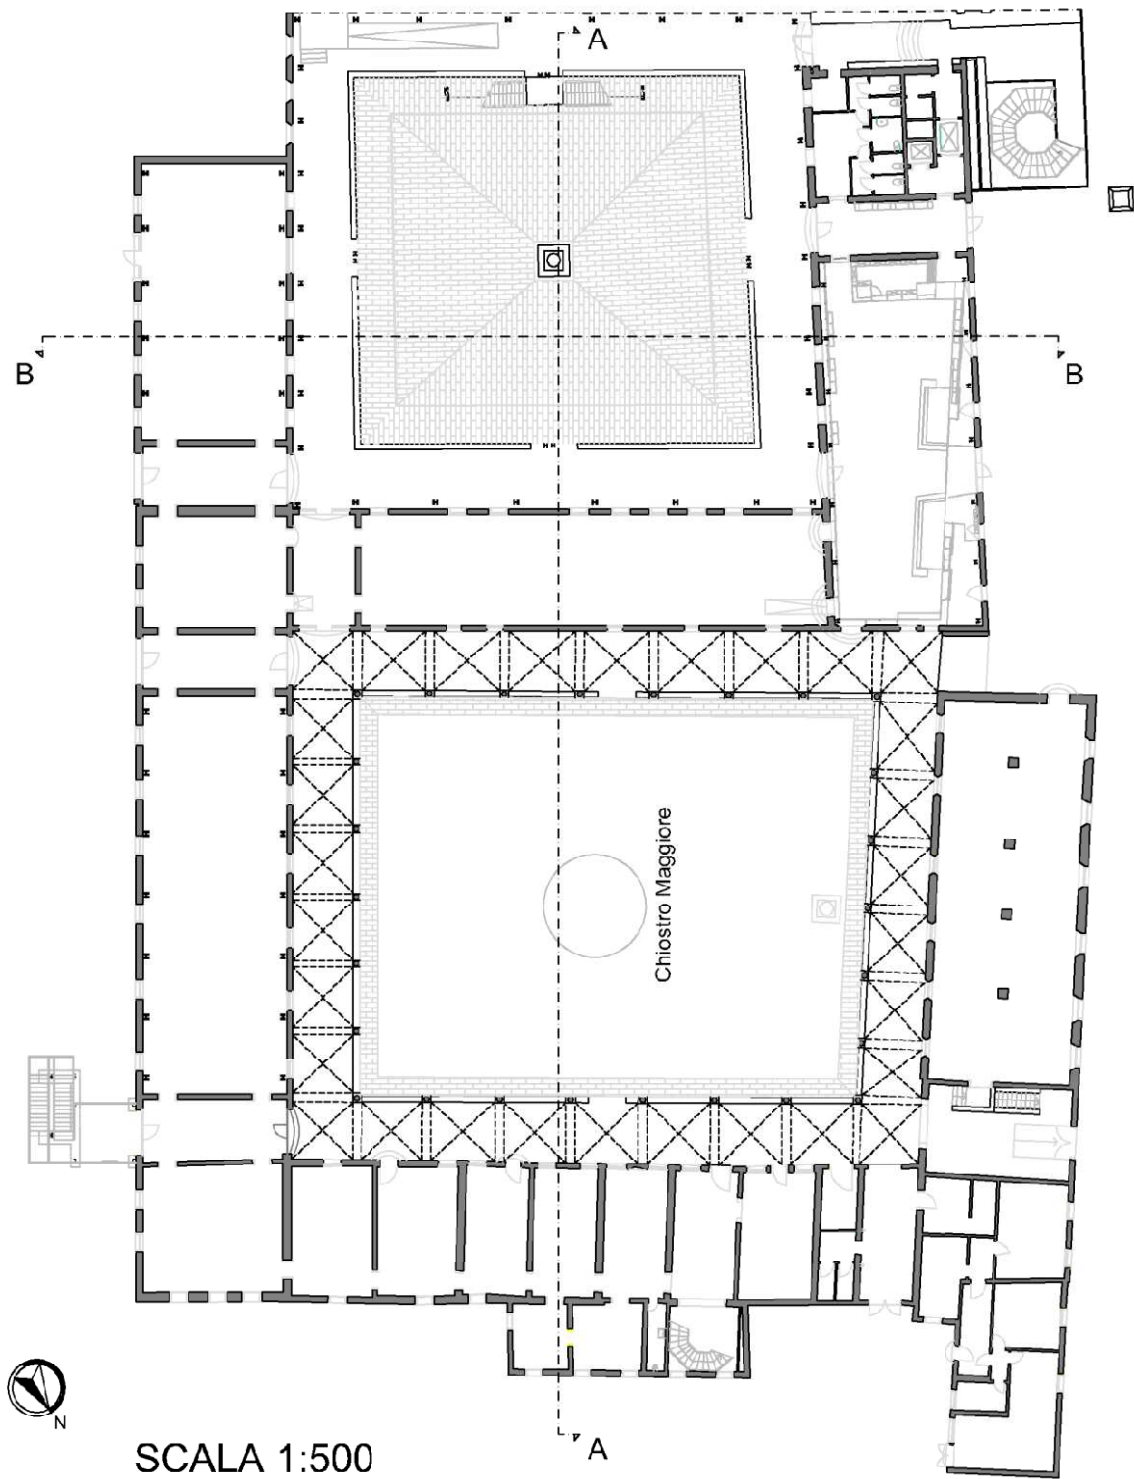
Pianta piano terra dei Chiostri degli Eremitani.
